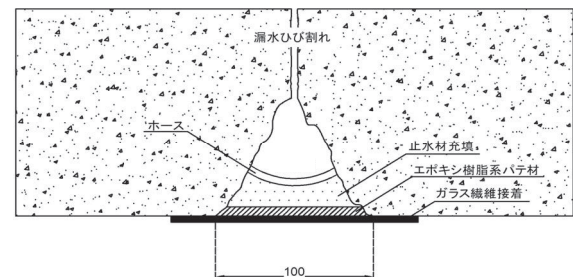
シート工概要図(1.5mm以上のひび割れ及び漏水部) (単位: mm)
